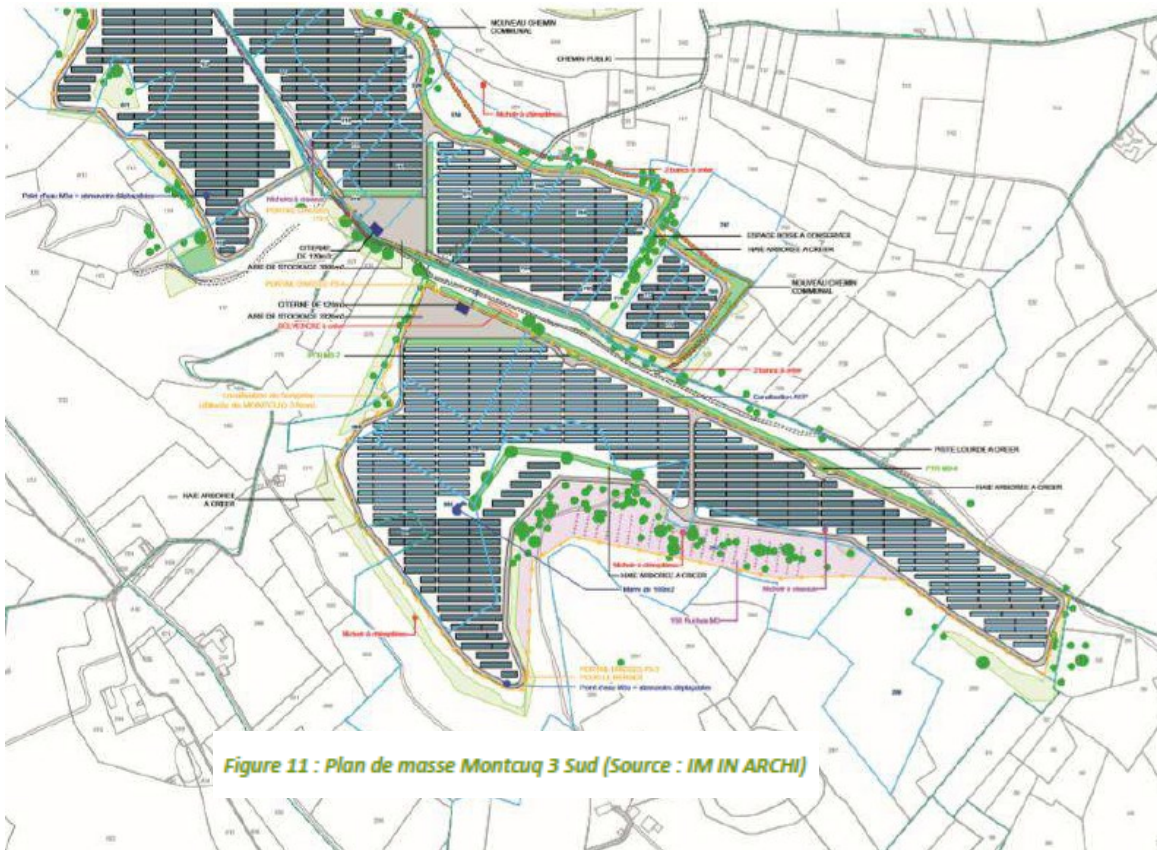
Plan de masse Montcuq 3 Sud (Source : IM IN ARCHI)
